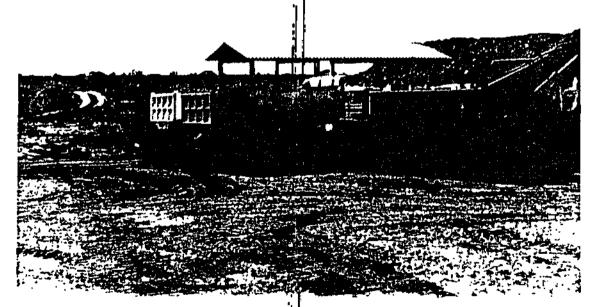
Detalhes da infraestrutura. La foto observa-se caminhões caçamba e retroescavadeira do empreen simento, no segundo plano, lado direito o muro da bacia de rejeitos.
